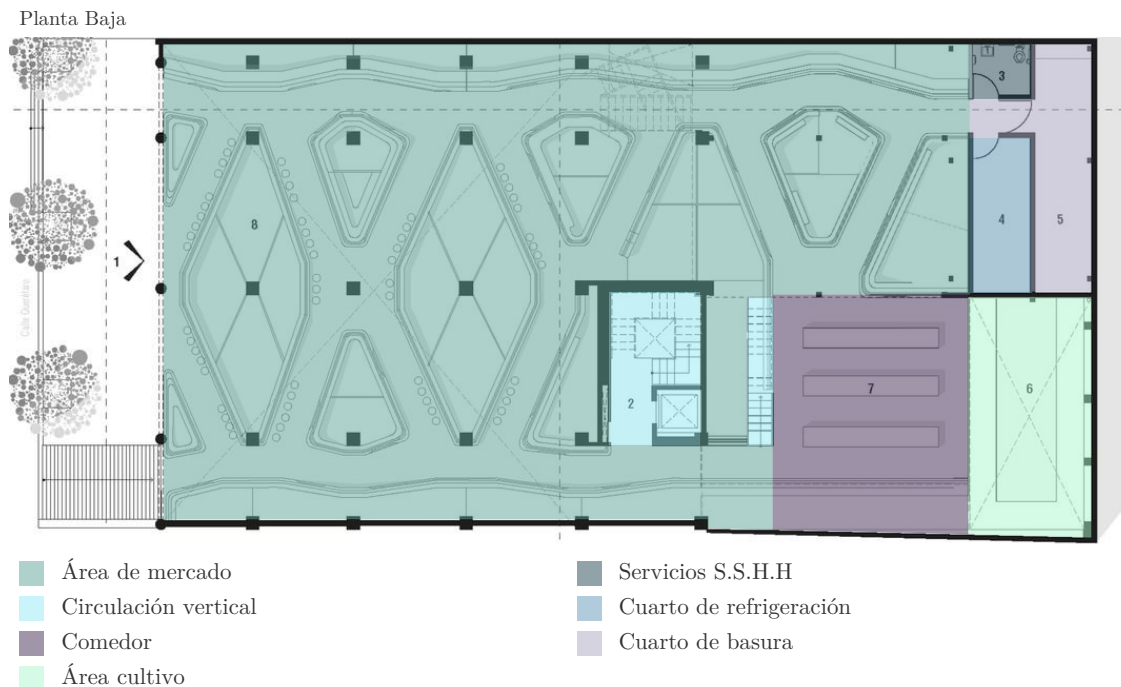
Planta Baja Mercado Roma. Elaborado: Autores.
